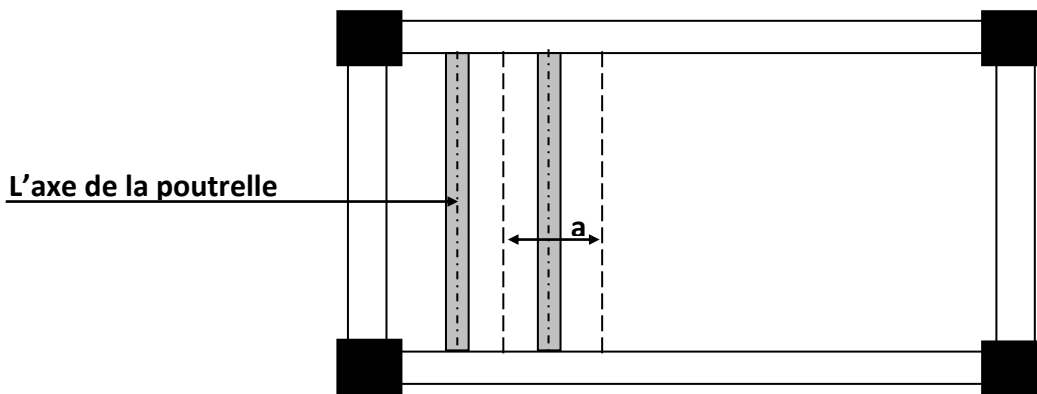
Plancher avec poutrelles pré fabriquées. (Disposition des poutrelles).
